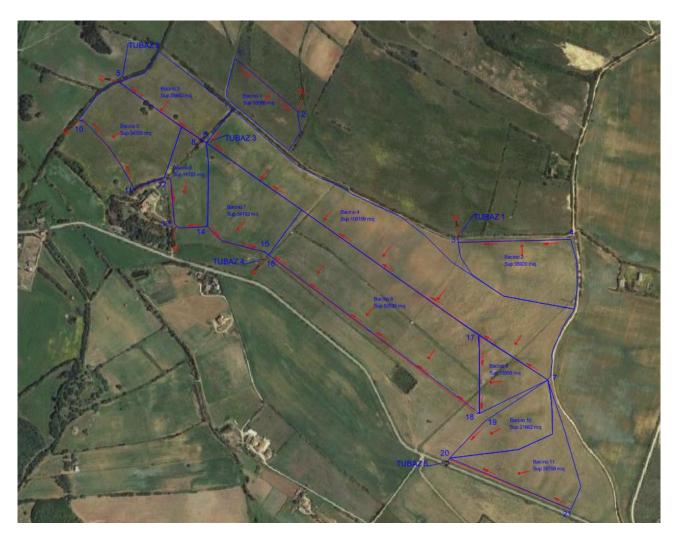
Planimetrie con individuazione dei bacini interni su ortofoto
